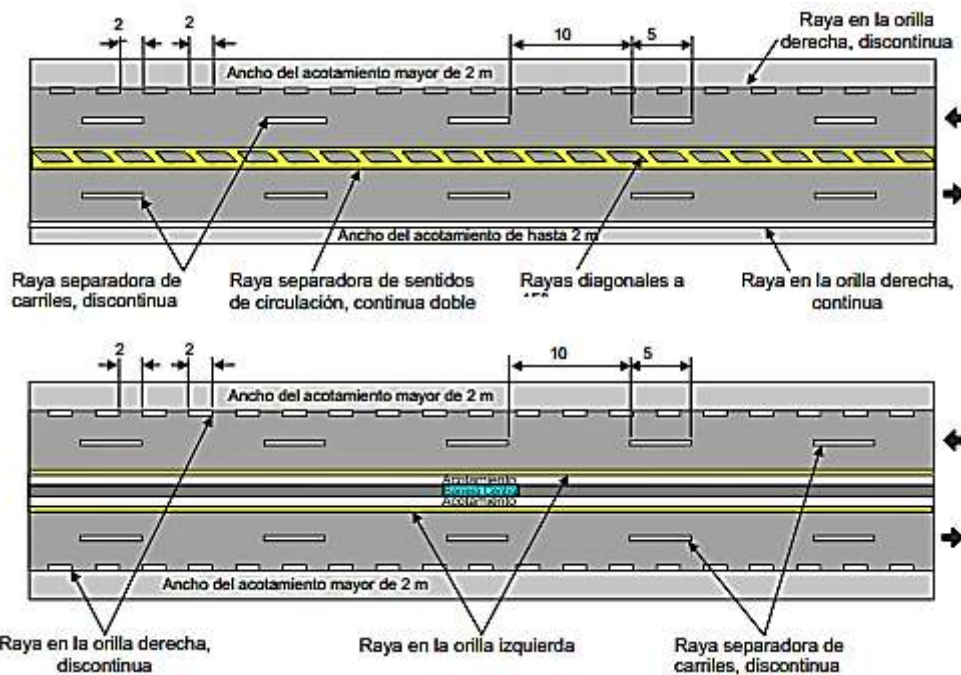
Marcas en el pavimento en autopistas y carreteras de 4 carriles
